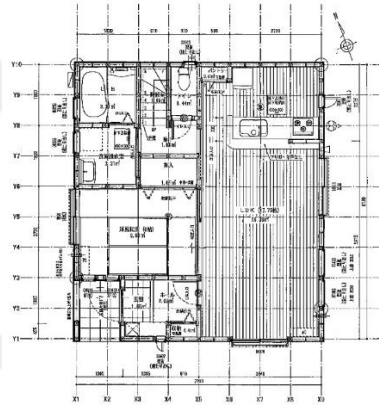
Japonya örneği, Vaziyet planı (Anonim 2017)
